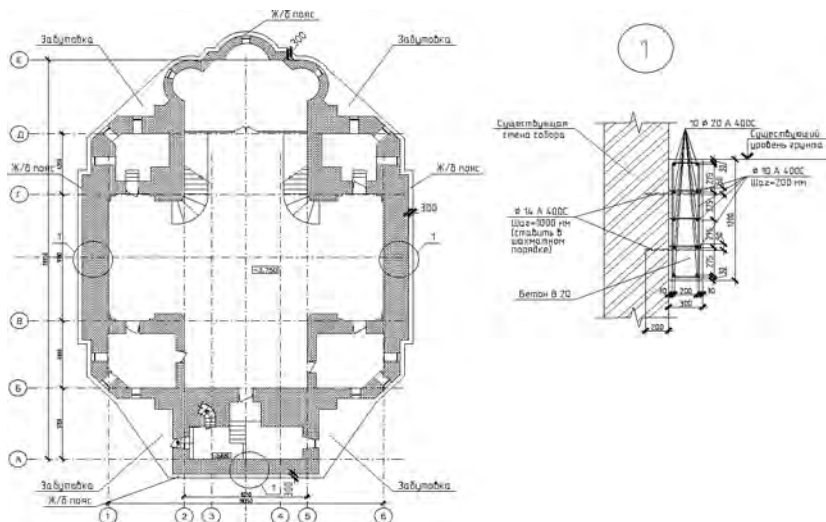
Схема расположения замкнутого монолитного железобетонного пояса по верху фундамента Собора Святого равноапостольного князя Владимира
